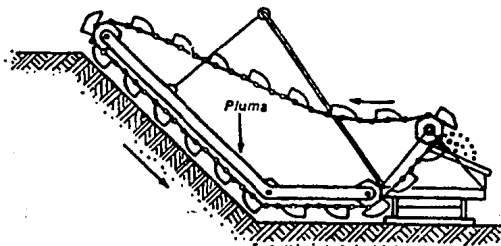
Excavadora trabajando por encima de su plano de apoyo.
